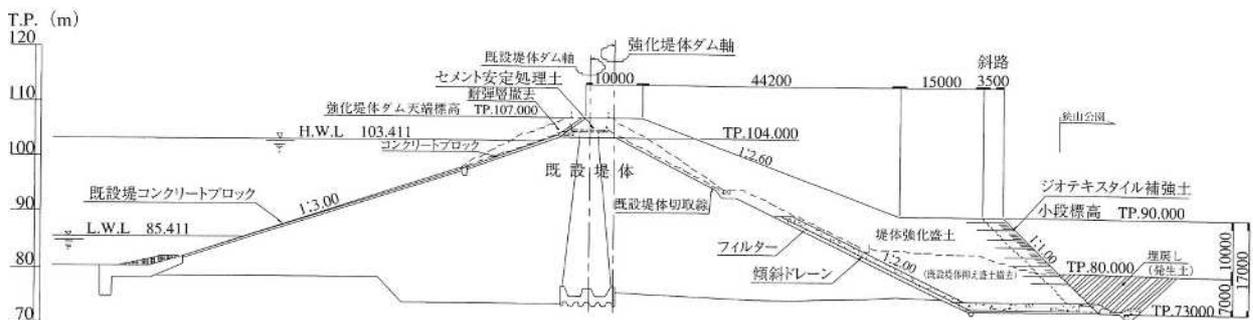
震度法による耐震設計で設定した堤体強化工法基本断面
